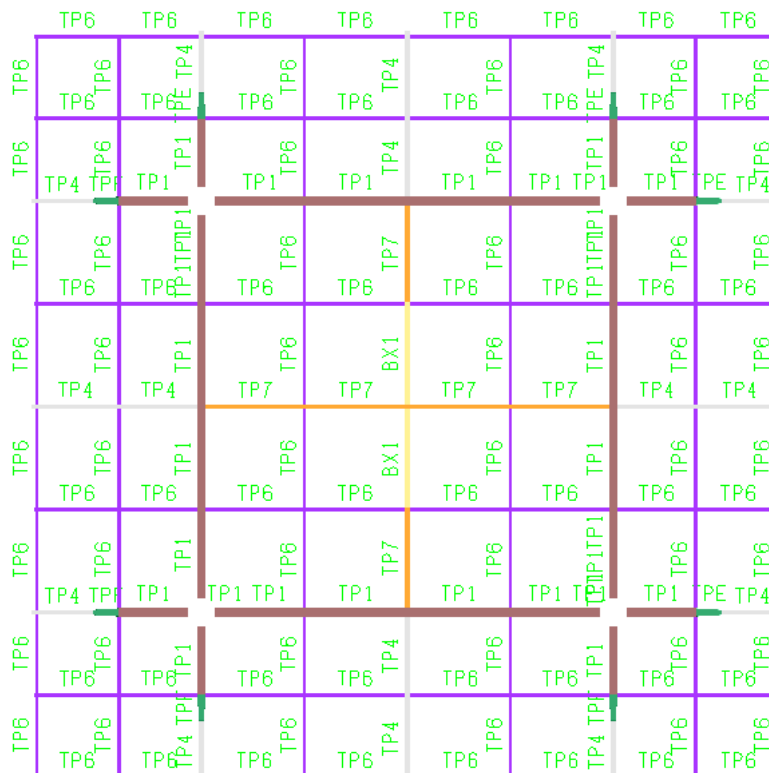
Elementi orizzontali a sezione aperta - impalcato Quota 19 m
